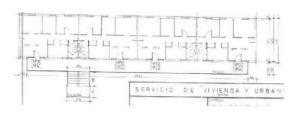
Planimetría - Villa Arauco/ Guixe Arquitectos Spa.
